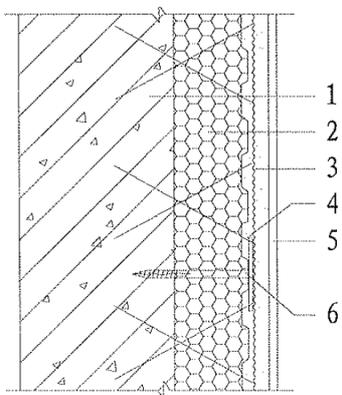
EPS 钢丝网架板现浇混凝土保温系统
